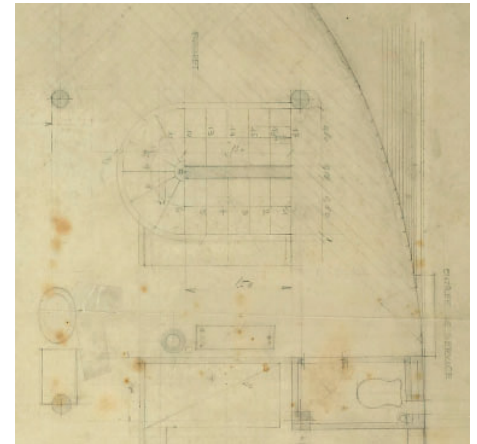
Croquis de la planta baja de la Villa Savoye a escala 1:20, Atelier LC-PJ. FLC 19529 (pormenor 2).
